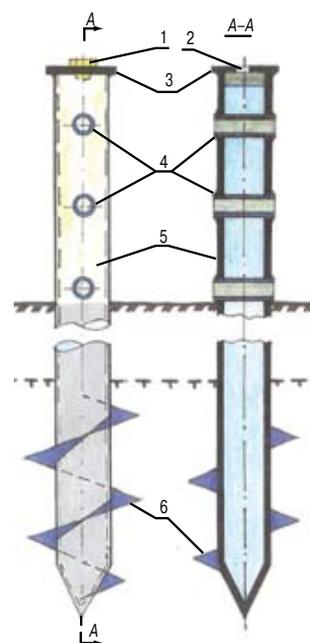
Винтовая инвентарная трубчатая термосвая (1 — герметичная пробка; 2 — отверстие в крышке сваи для заливки керосина; 3 — крышка сваи; 4 — втулки для штырей; 5 — ствол сваи; 6 — винтовая лопасть)
